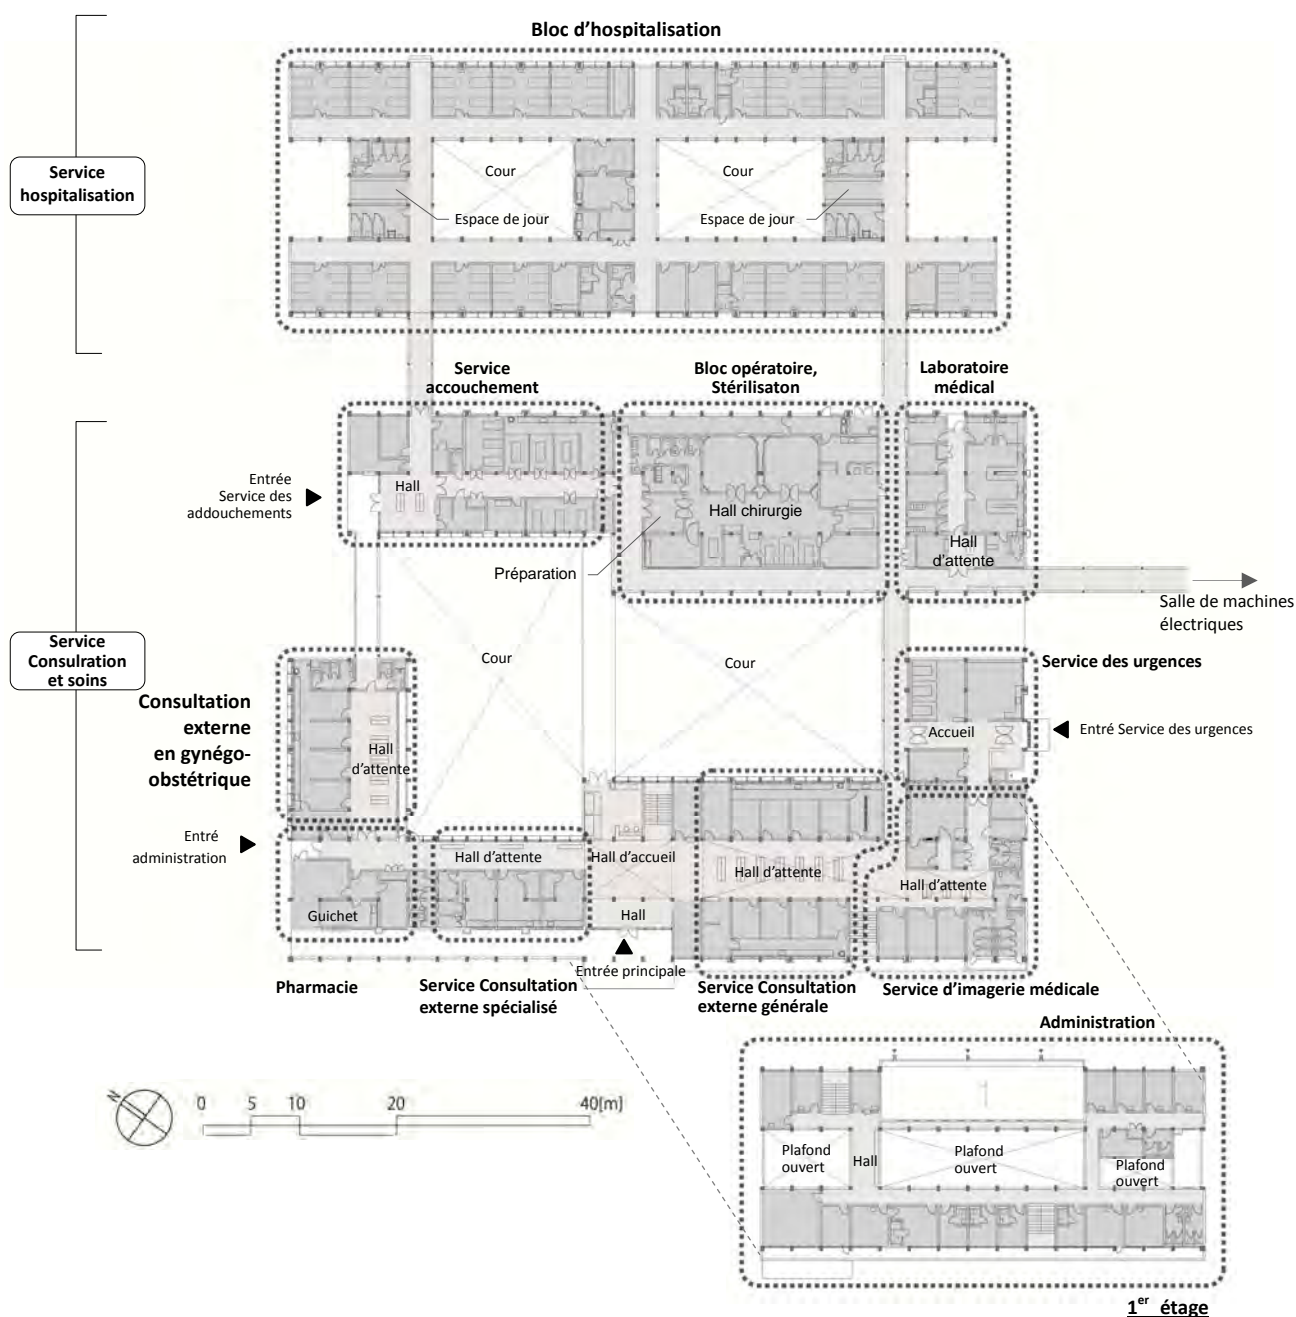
Plan horizontal des infrastructures de l'Hôpital d'Allada
